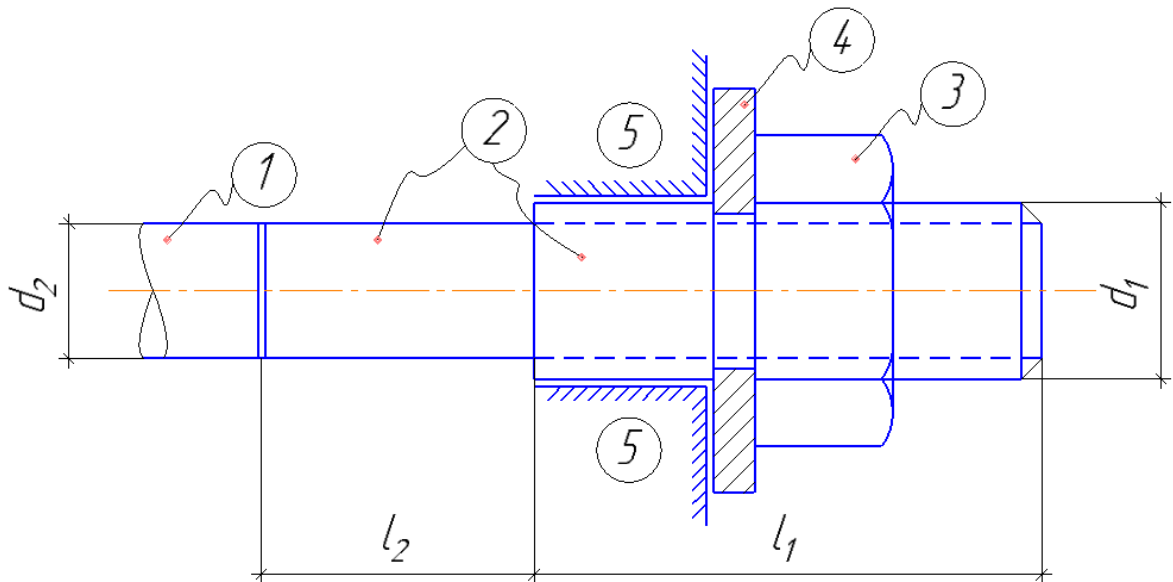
Гаечный анкер: 1 – стержневая затяжка; 2 – концевой элемент с резьбой; 3 – гайка; 4 – упорная шайба; 5 – узел конструкции
